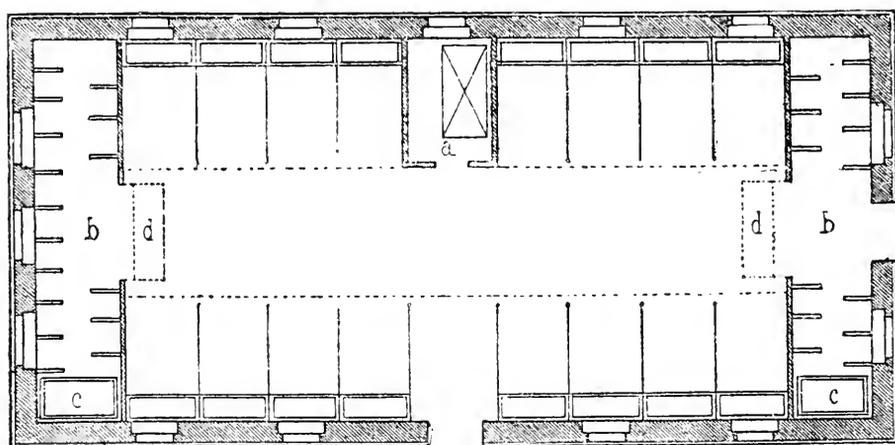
PLAN D'UNE ÉCURIE LONGITUDINALE DOUBLE.
